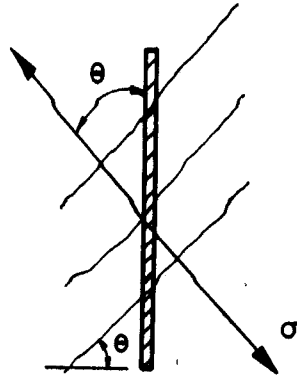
INCLINAÇÃO DAS FISSURAS EM RELAÇÃO À DIREÇÃO DAS BARRAS TRANSVERSAIS - LEONHARDT ⁵²
